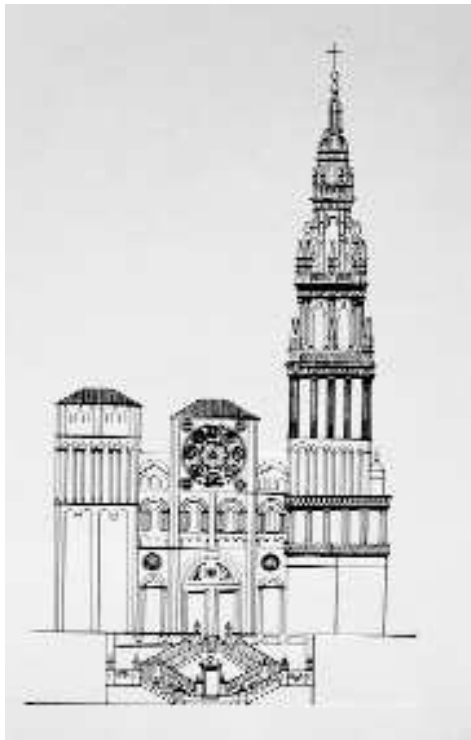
Reconstitución conjetural de la fachada del Obradoiro con la Torre de las Campanas (Dibujo de Vi-
